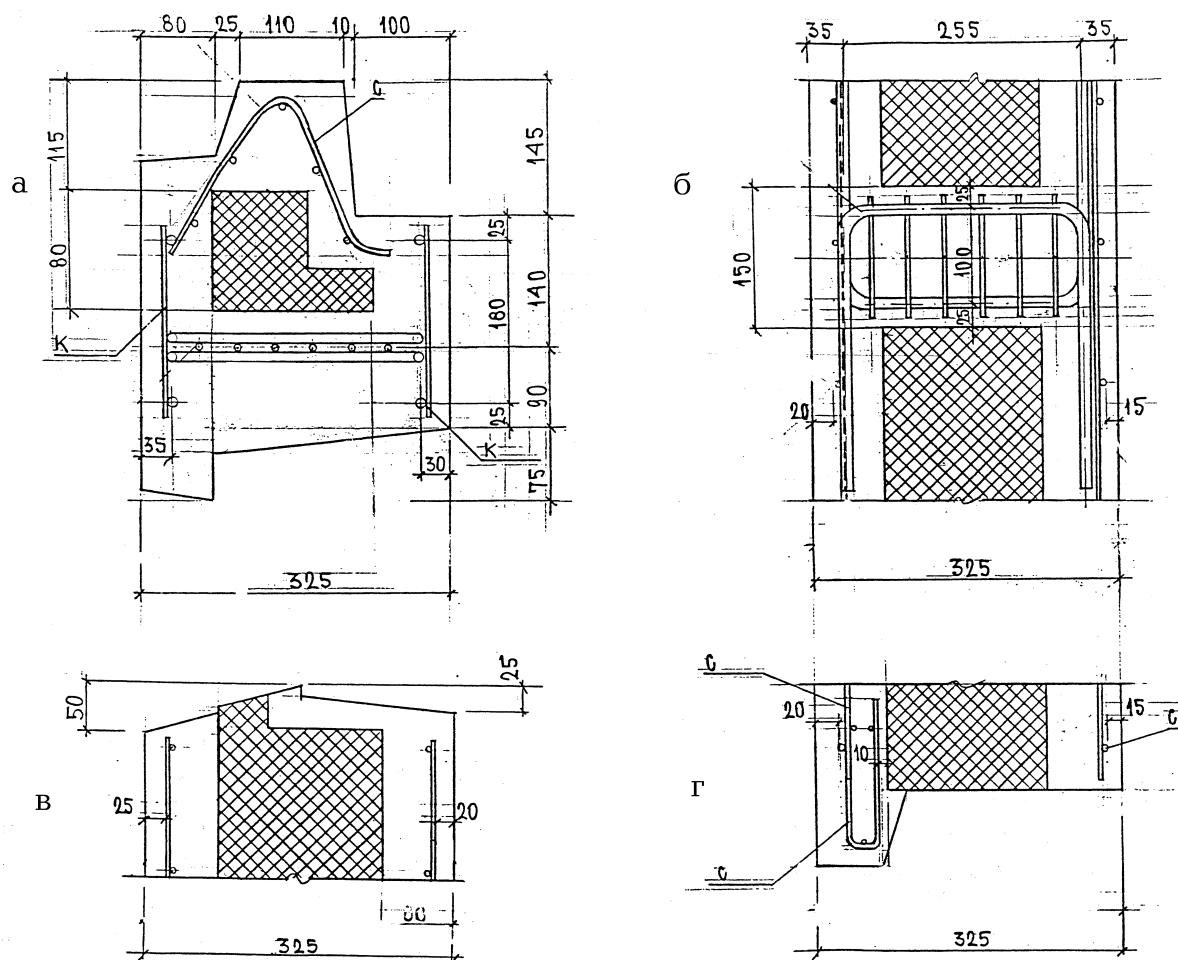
Детали сечений трехслойной панели со шпюночными связями: а - армирование стыкового гребня; б - то же, соединительной шпонки; в - подоконных зон; г - надоконных зон.
